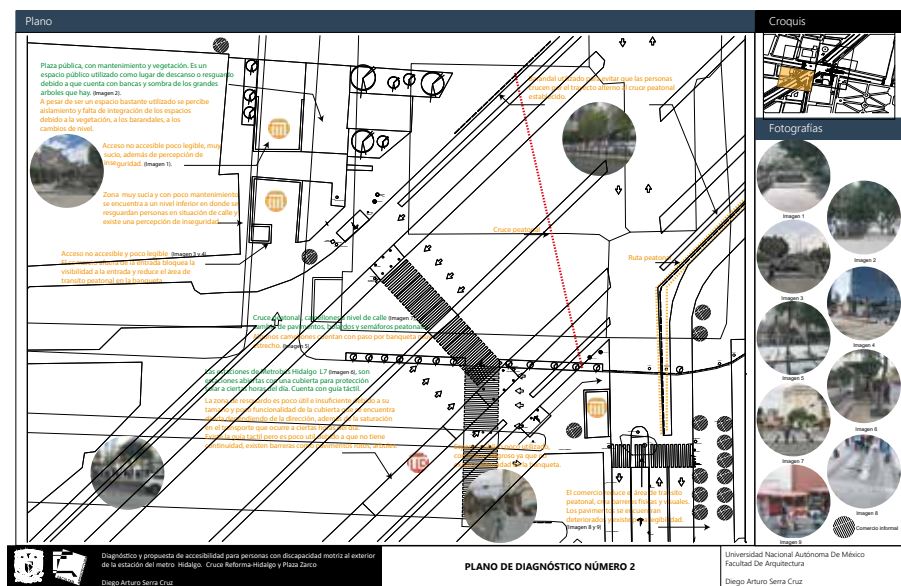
Planos diagnóstico 2. Ver anexo de planos de diagnóstico 1-5. Elaboración propia
